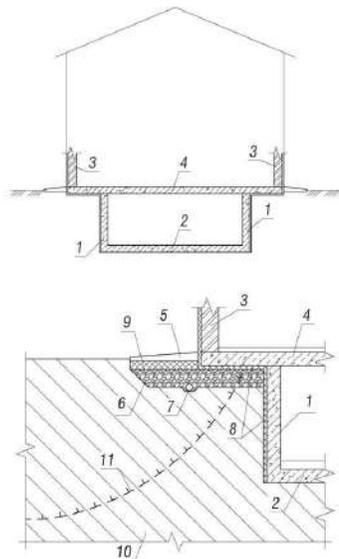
Новая конструкция фундамента здания с подземным этажом на пучинистом грунте, предложенная А. В. Мельниковым
